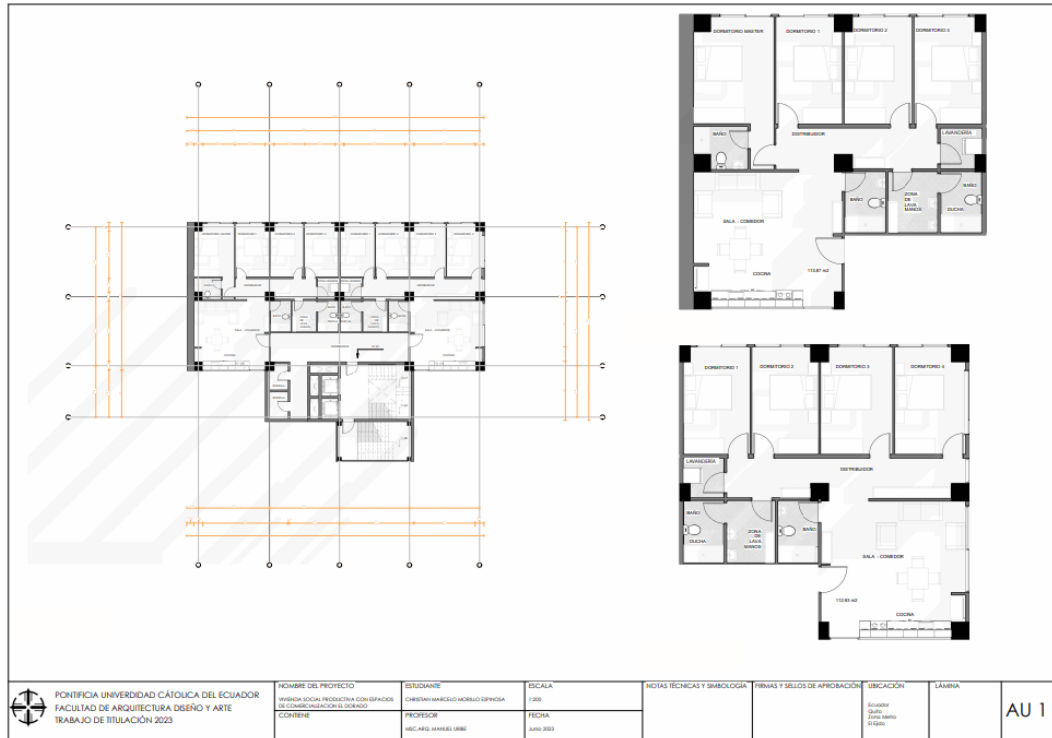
Bloque Reciclaje – Planta Tipo Vivienda. (Morillo C. 2023)
